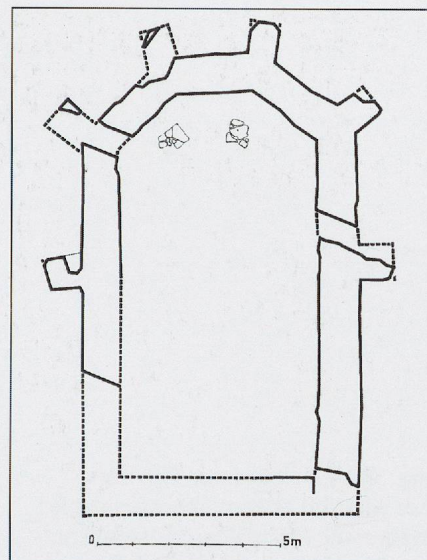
La chapelle Saint-Roch (1522–1523) à Lausanne, par Jean et Pierre Contoz. Plan des fondations retrouvées en 1958, selon Pierre Margot (*MAH, Vaud, IV*).
